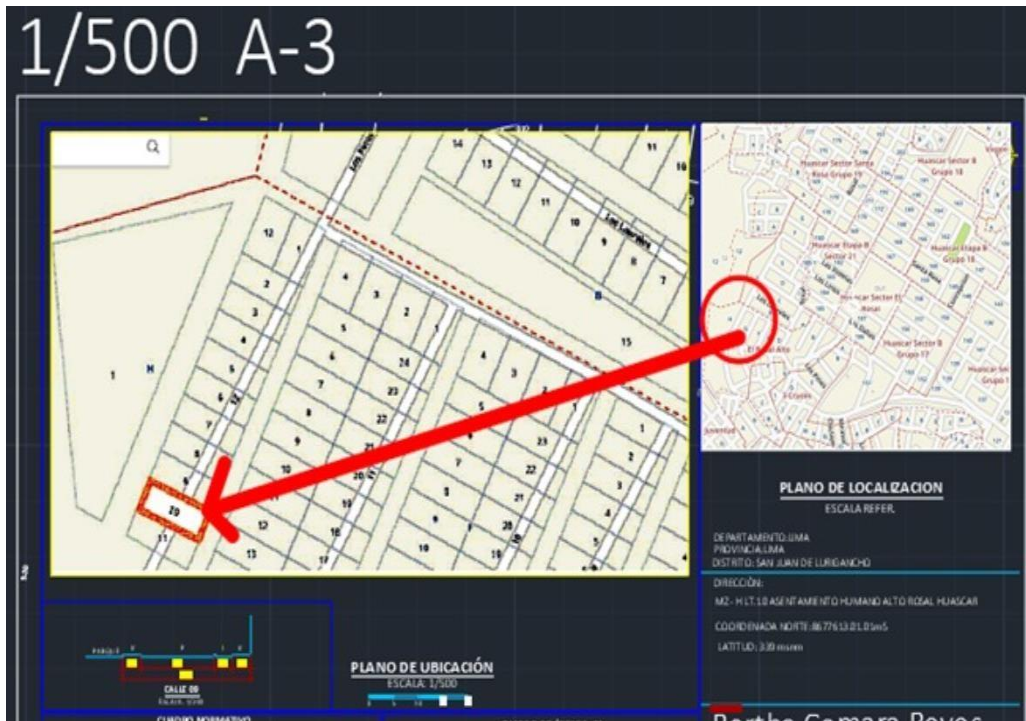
Croquis de la ubicación del terreno a considerar para el modelamiento estructural.
